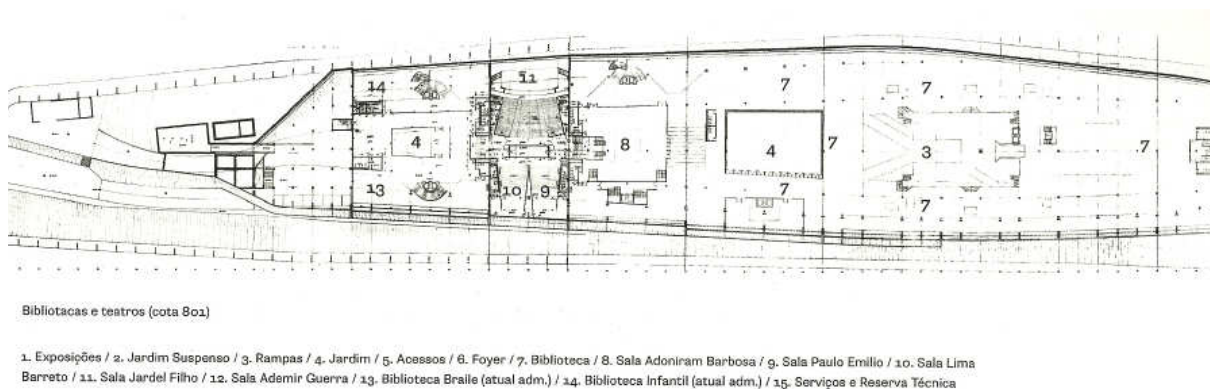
Planta do pavimento térreo do CCSP. Fonte: SERAPIÃO, 2012, p. 76.
